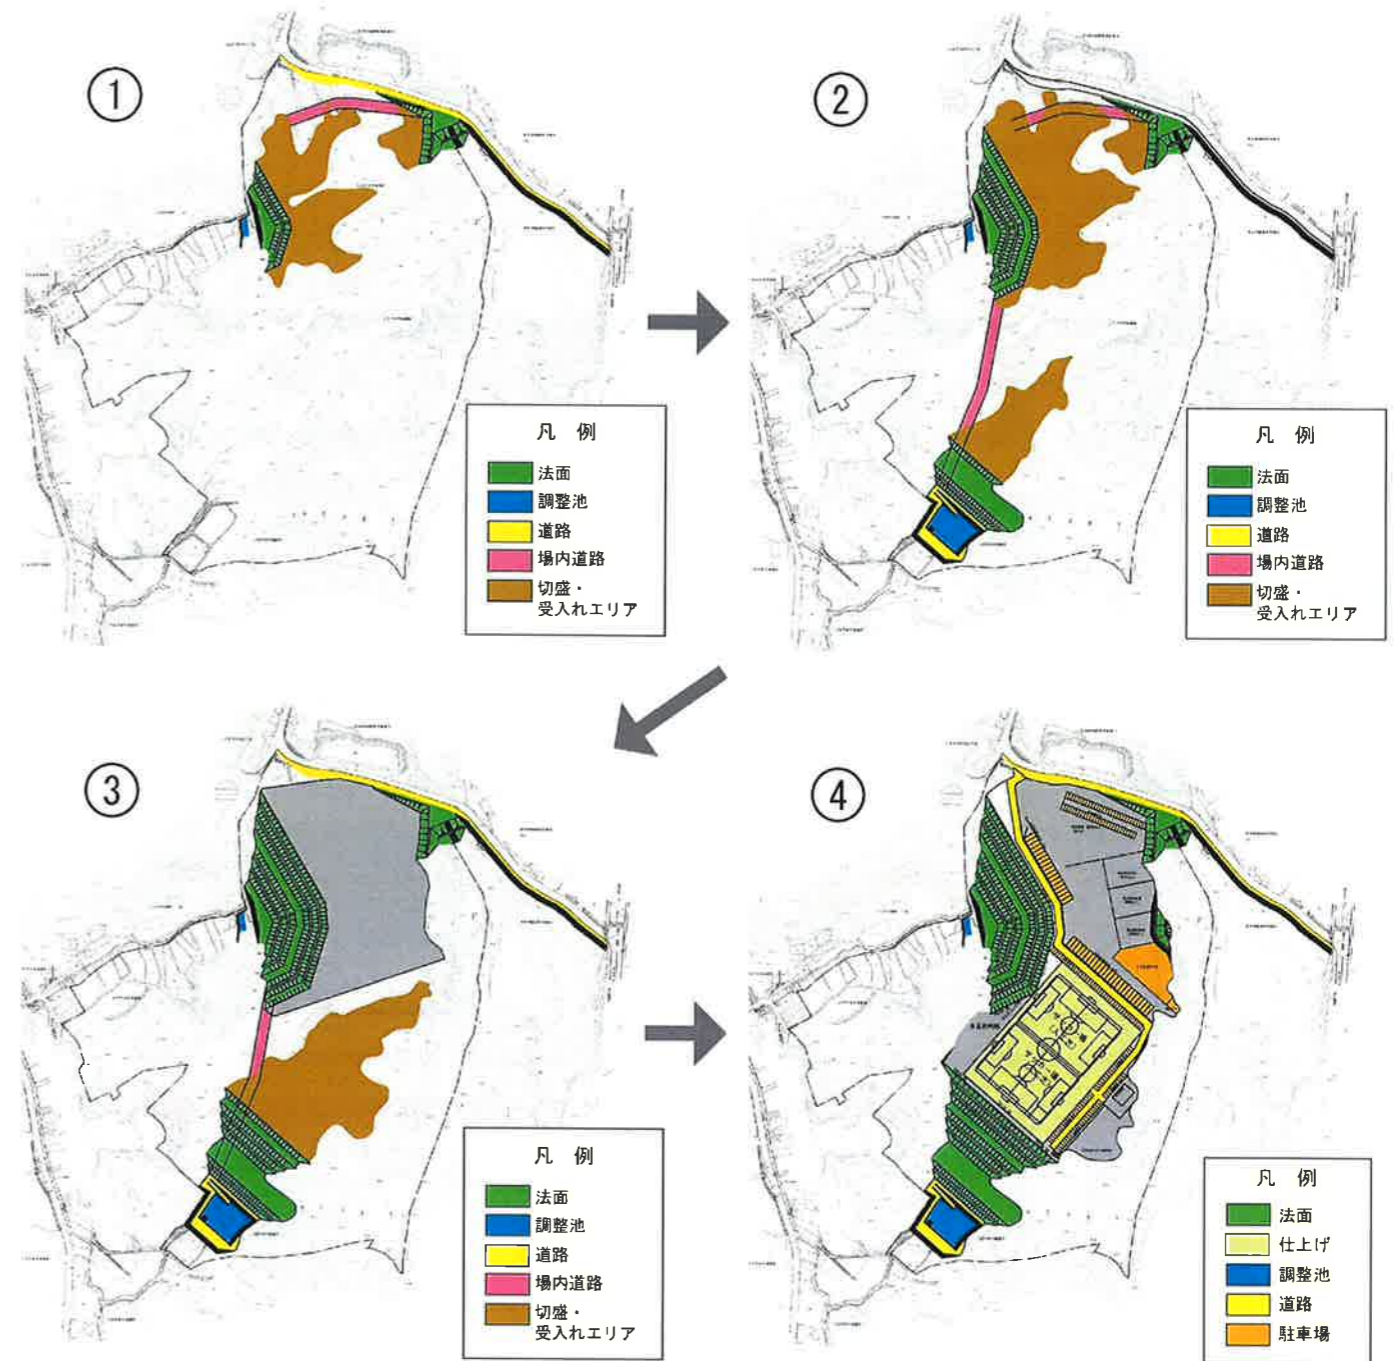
段階施工による退避路の確保・施工ステップ図
